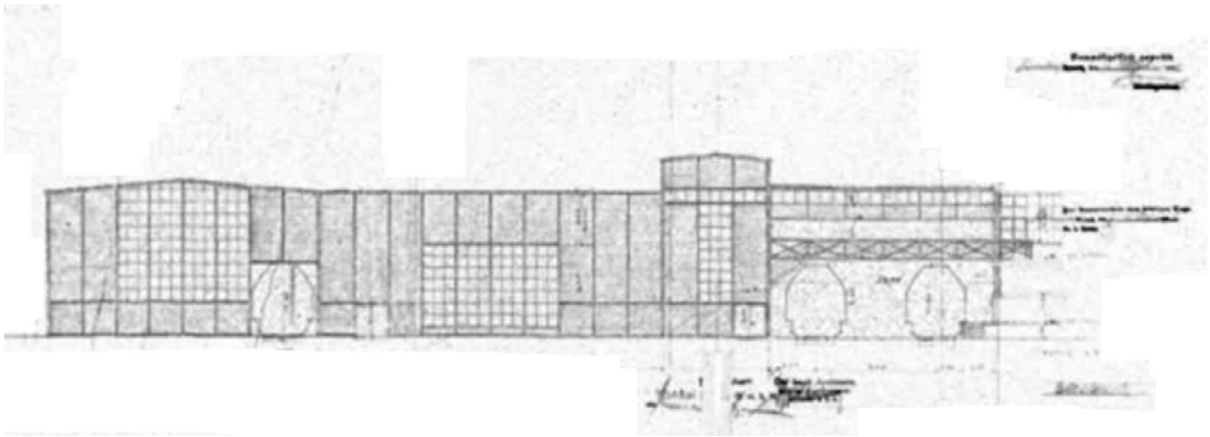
Kistenfabrik Geb. B 03, 1929 - Architekt: Walter Furthmann
